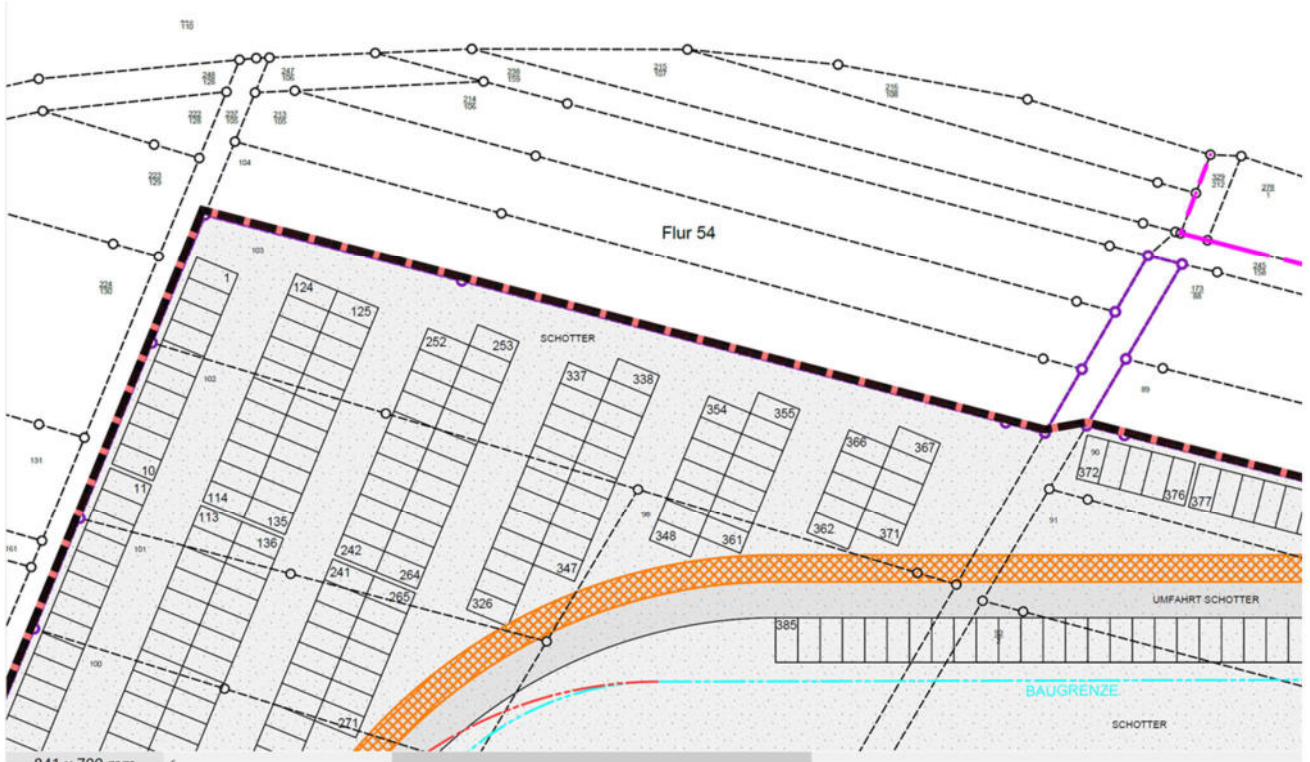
Lageplanausschnitt Beckenstandort RRB Nord
